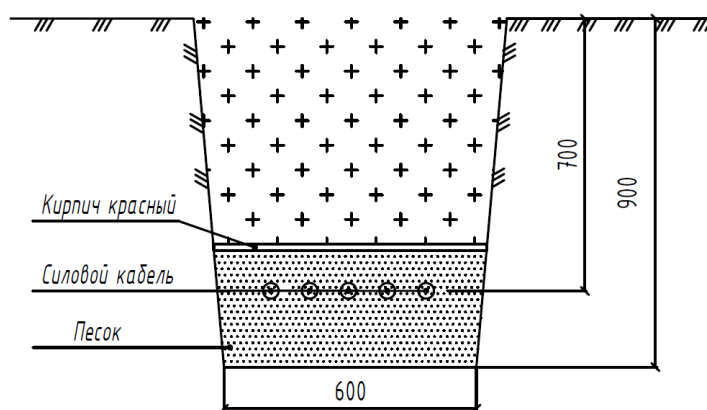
Внешний вид кабельной траншеи типа Т-5 для прокладки пяти кабелей
